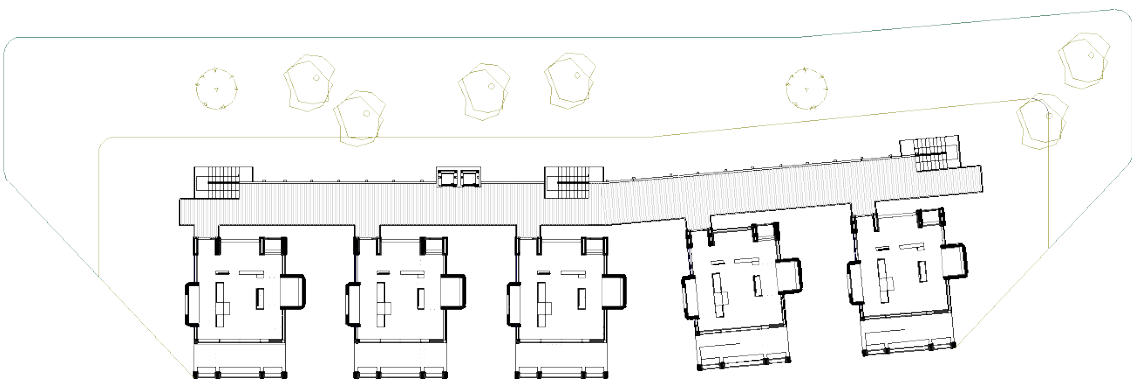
Planta de la agrupación de viviendas en hilera. (Realizado por el equipo Urcomante)
